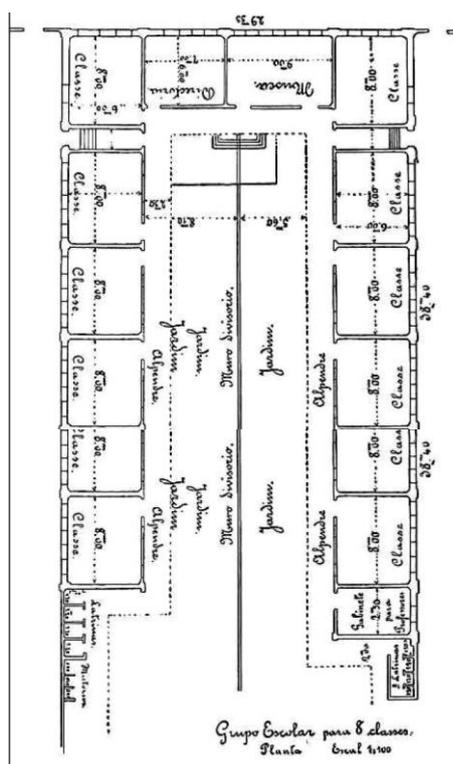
Planta Baixa Grupo Escolar de Uberaba
